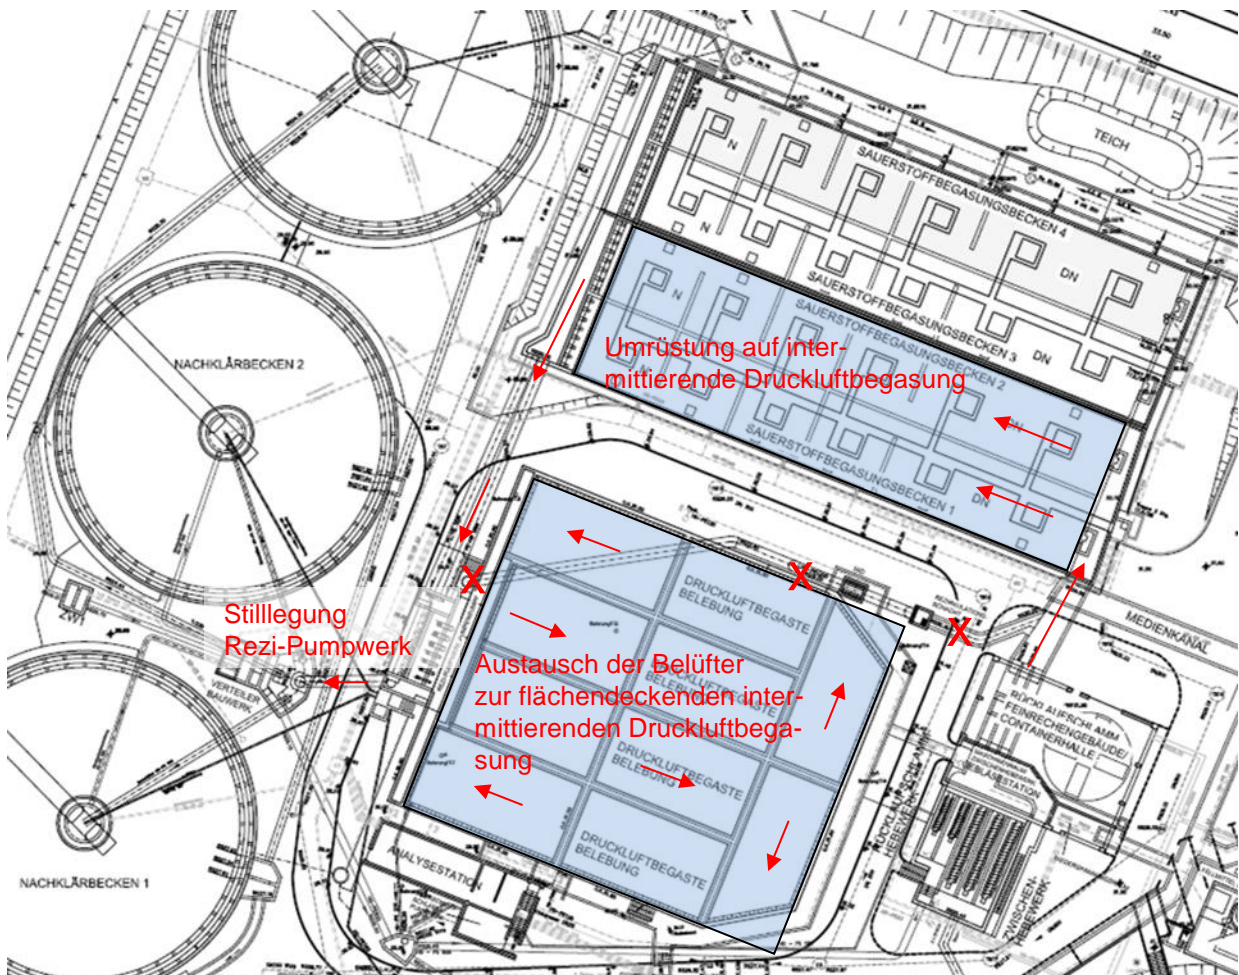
Lageplan Kläranlage Hochfeld – Umrüstung auf intermittierende Denitrifikation, Variante 1a
